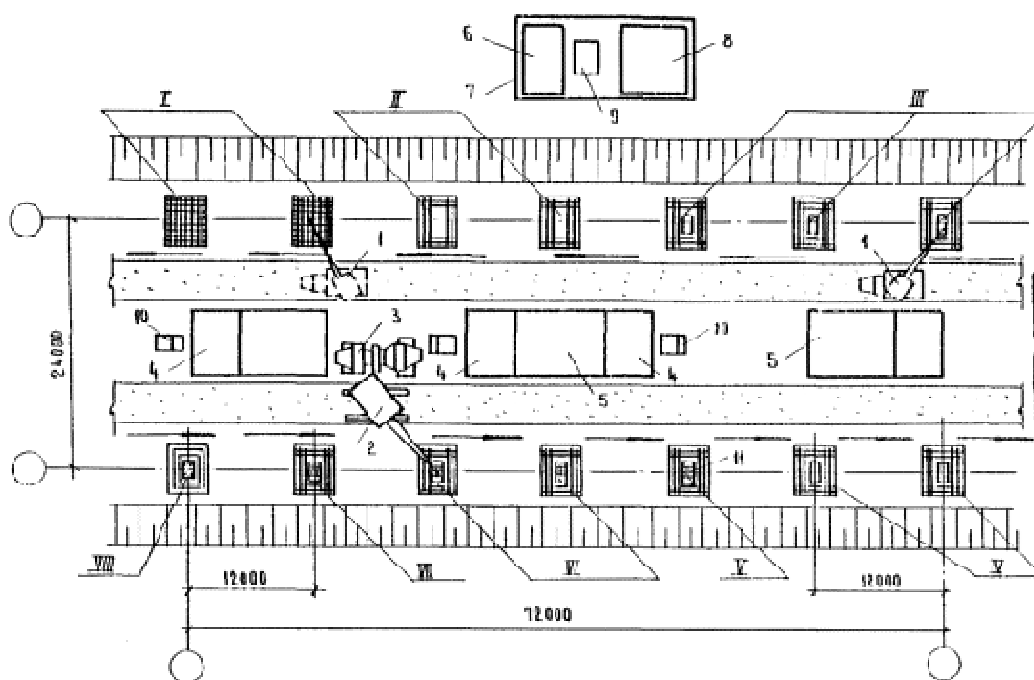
Схема влаштування монолітних фундаментів під колони при укладанні бетонної суміші за допомогою стрілових самохідних кранів
